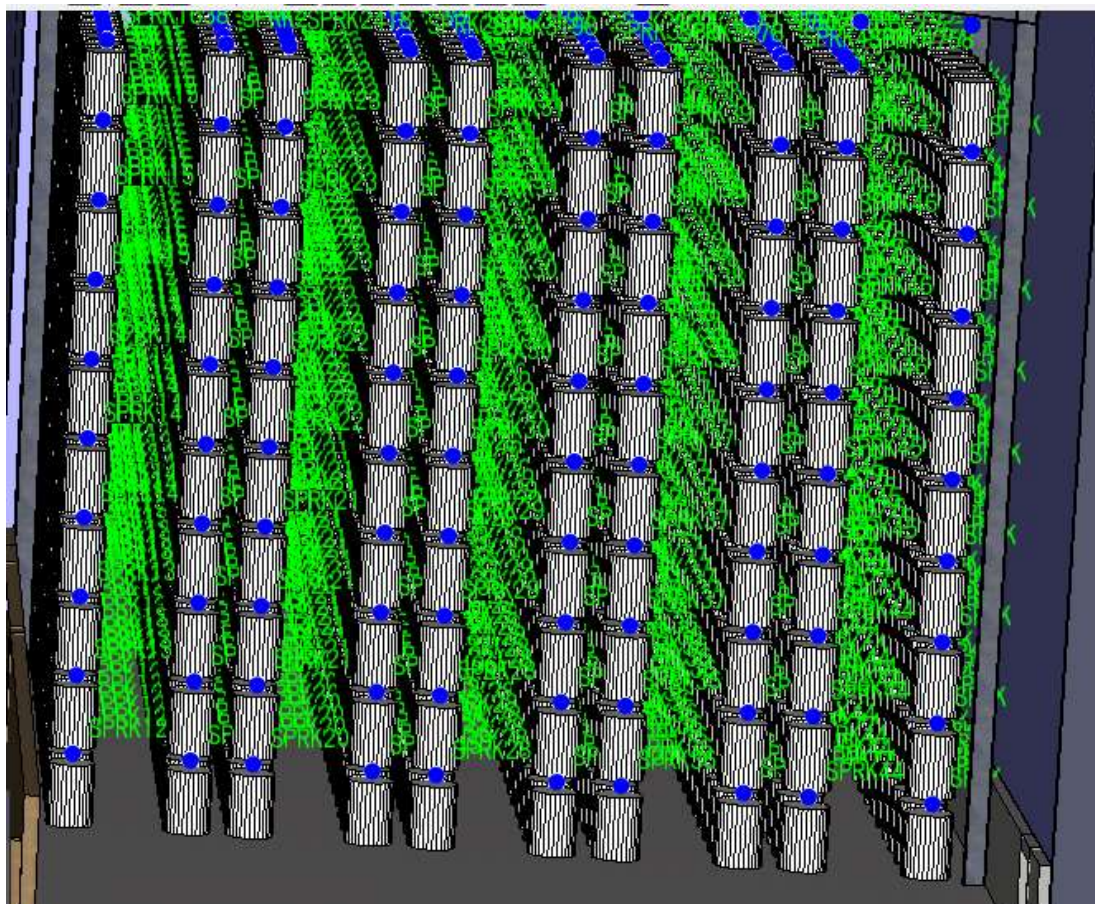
Pormenor dos sprinklers no armazém PRS2
